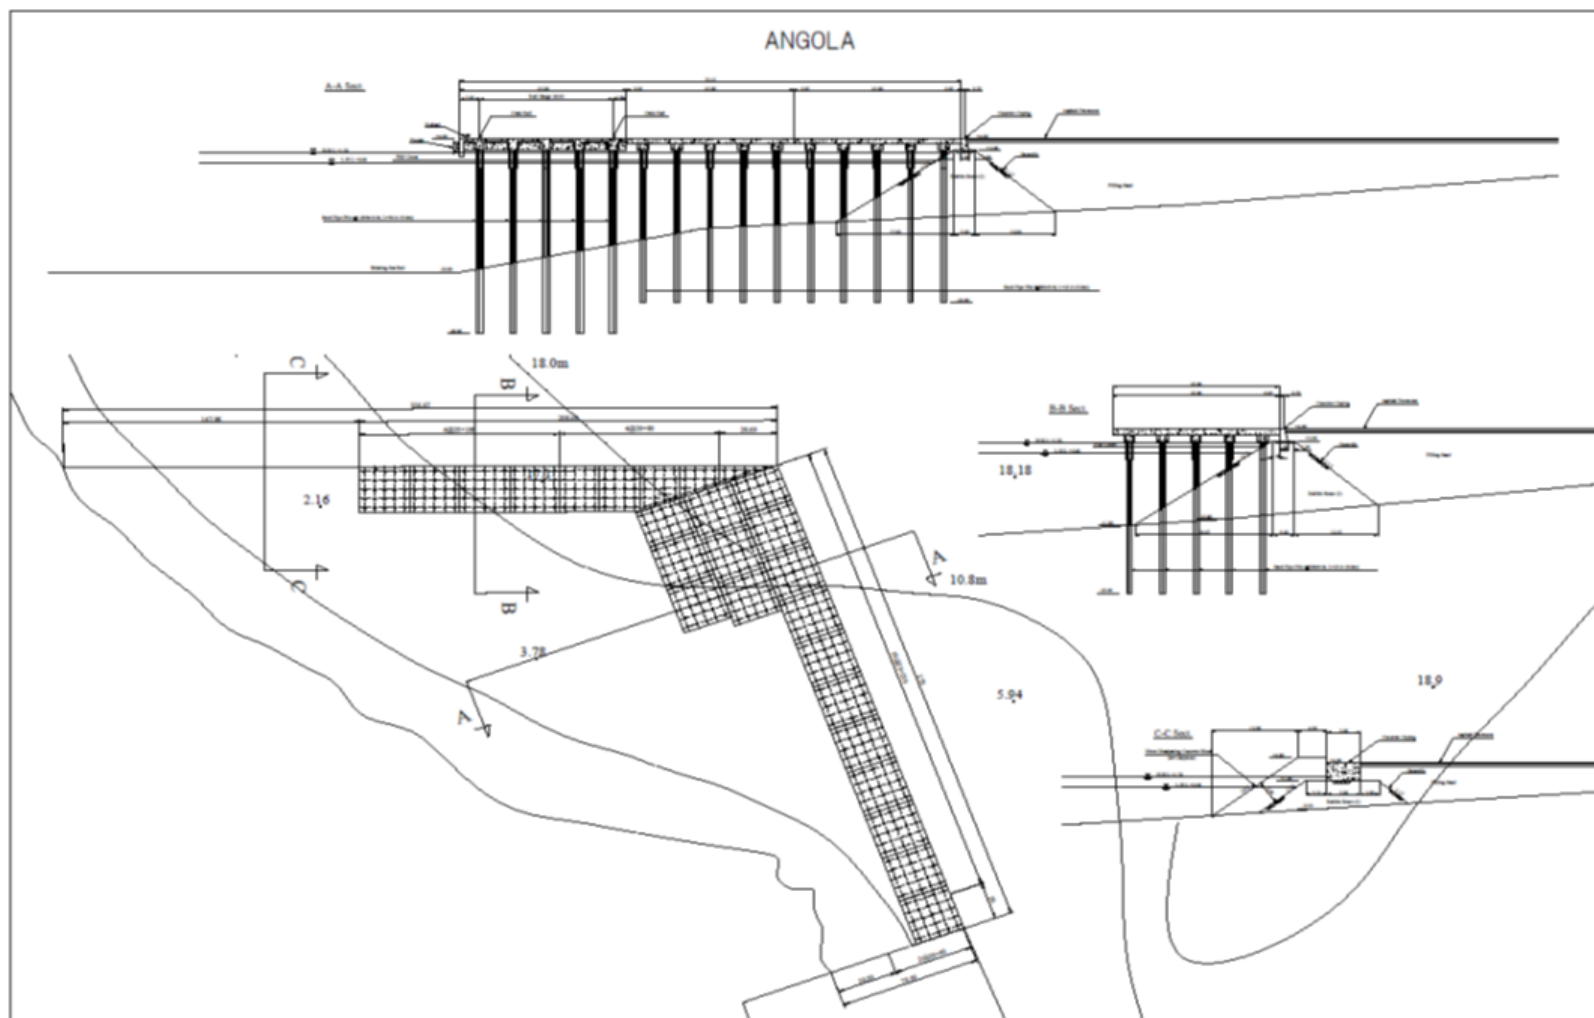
Baía de Namibe - Plano para a proposta expansão ao terminal existente ilustrando a configuração e estruturas do lado do mar
